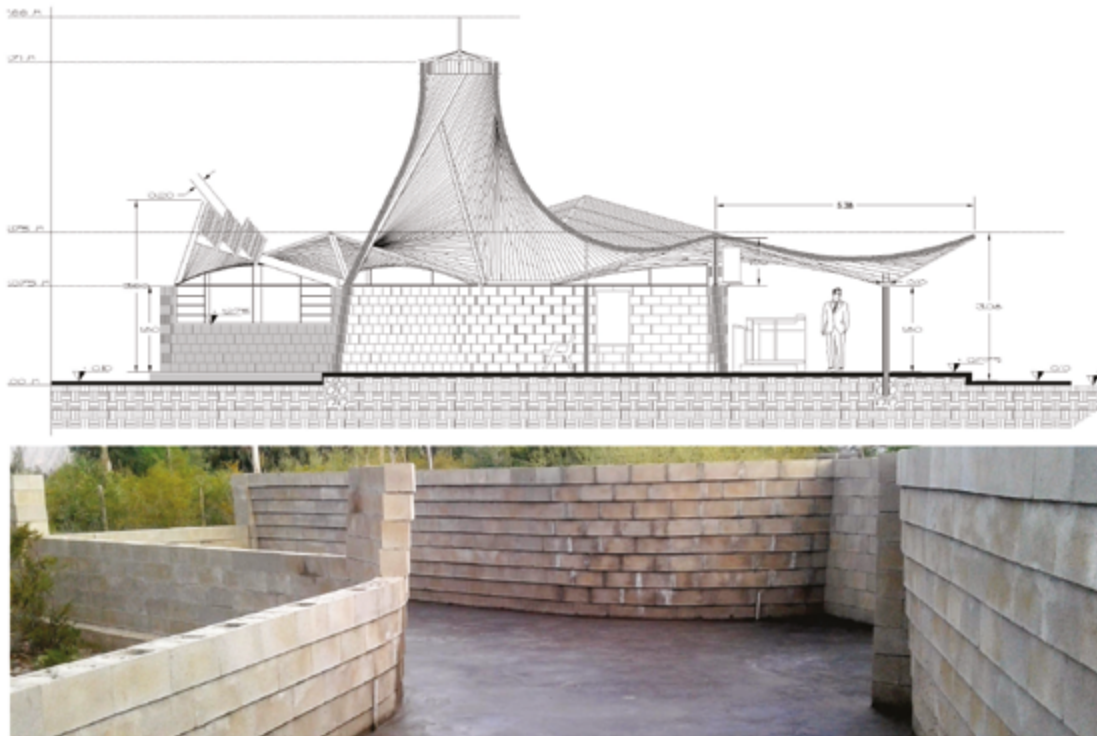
Sección del objeto arquitectónico. Muros construidos. Elaboración propia.
